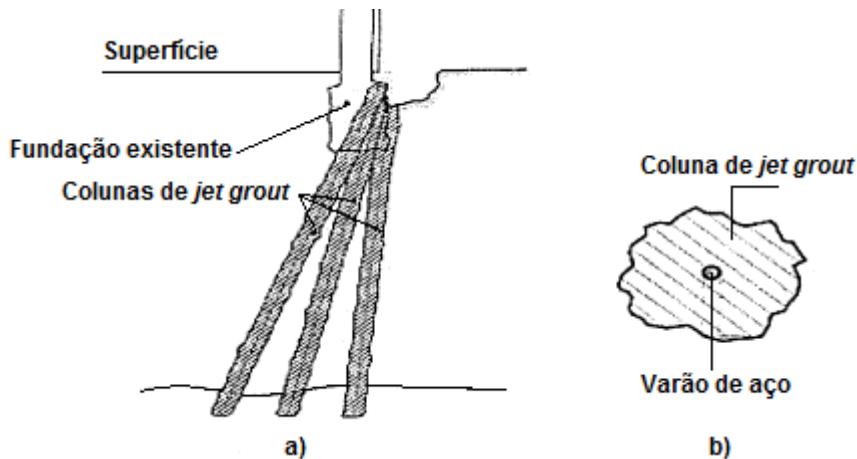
Recalce da fachada do hotel por colunas de *jet grout*: a) corte; b) seção da coluna [73]
